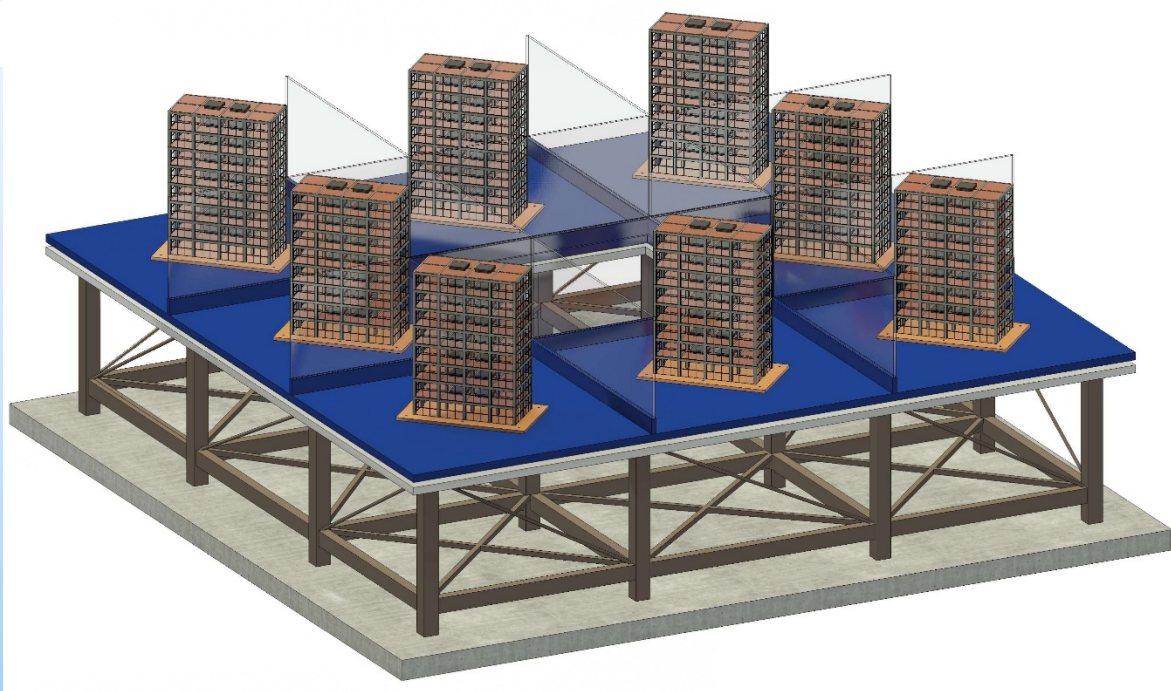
Potongan A Model Bangunan Gedung 8 lantai dari Baja atau Beton Pracetak
